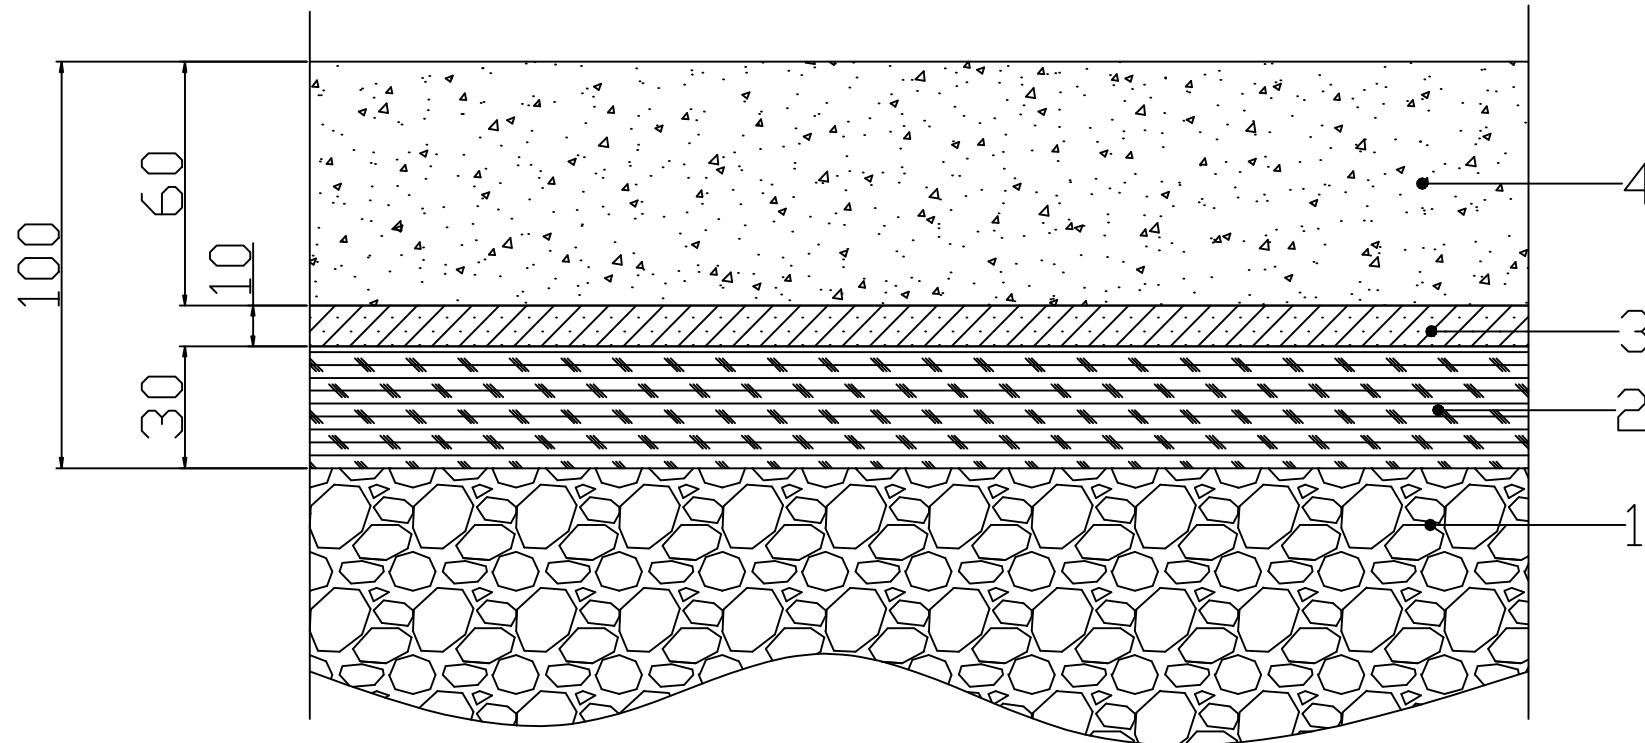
Вертикальный разрез звукоизоляционной основы перекрытия
